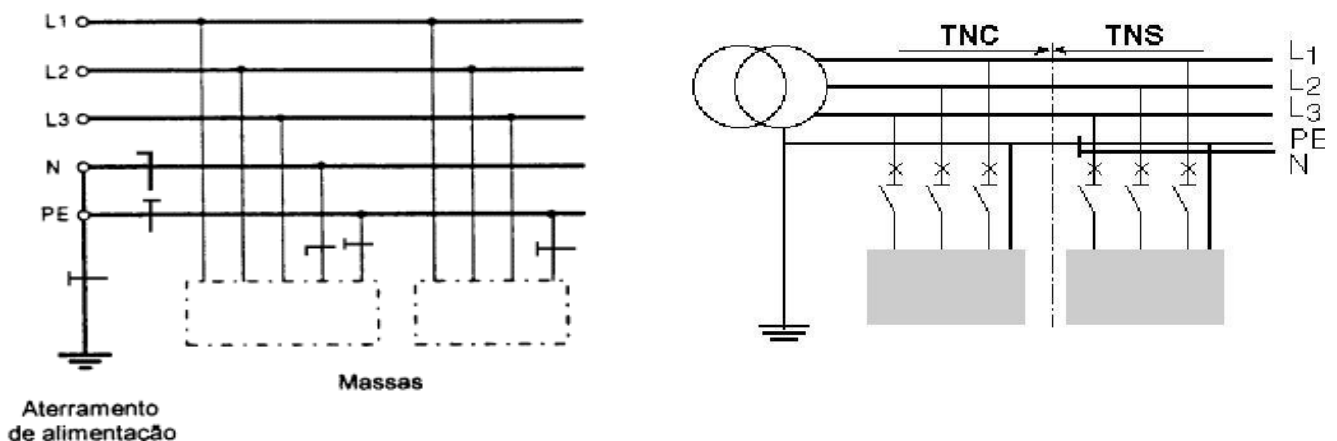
Esquema TN-S. Condutor neutro e condutor de proteção separados ao longo de toda a instalação.
